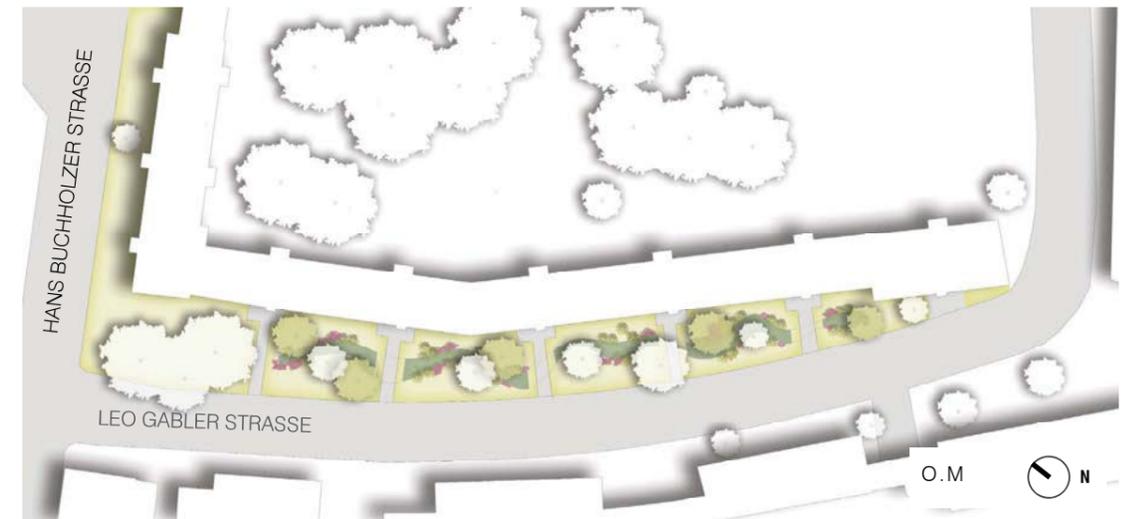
Sickergruben Leo-Gabler-Straße, Darstellung: DnD Landschaftsplanung
